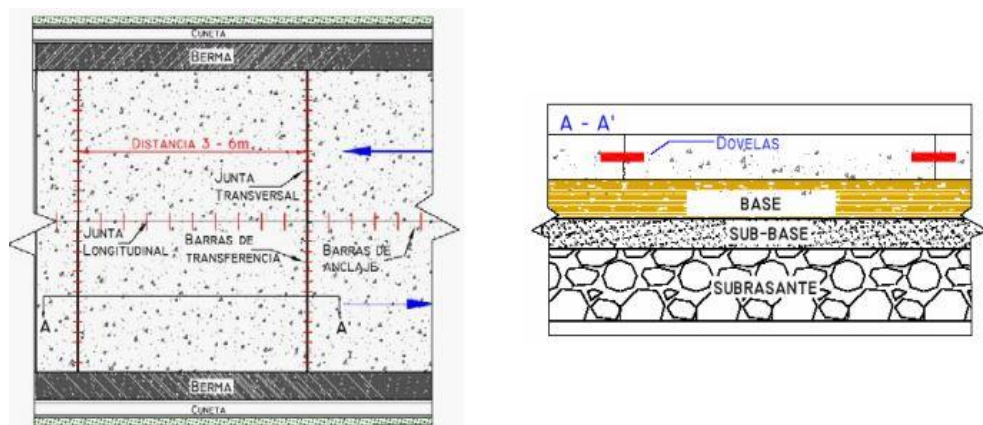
Losas de concreto simple con juntas. Fuente: INVIAS, 2006.
